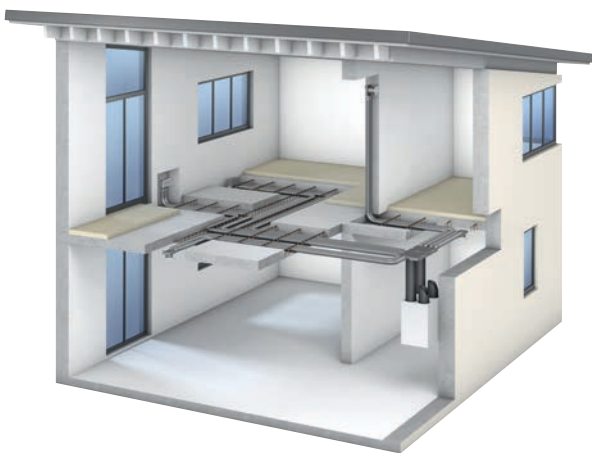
Zentrale Wohnraumlüftung in der Betondecke eingebaut
